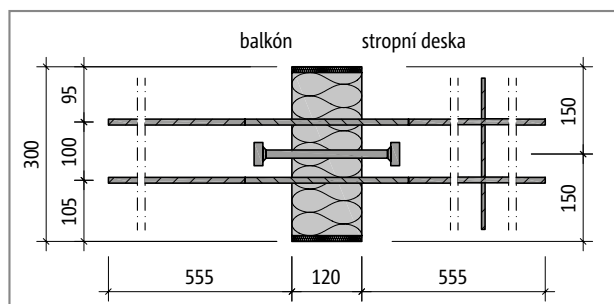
Schöck Isokorb® typ QPXT70: Půdorys prvku
